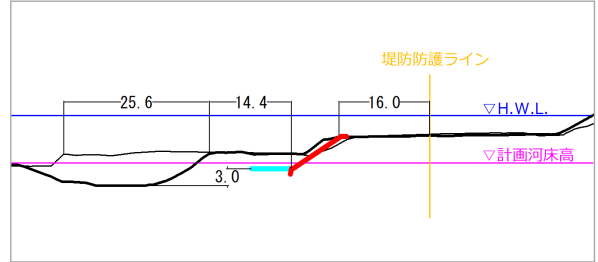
照査対象護岸① CIMモデルから抽出した横断面図
